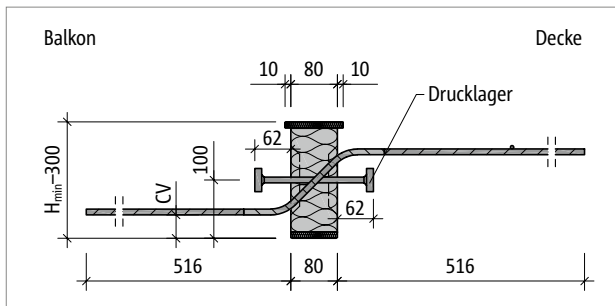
Schöck Isokorb® T Typ QP-V5: Produktschnitt
